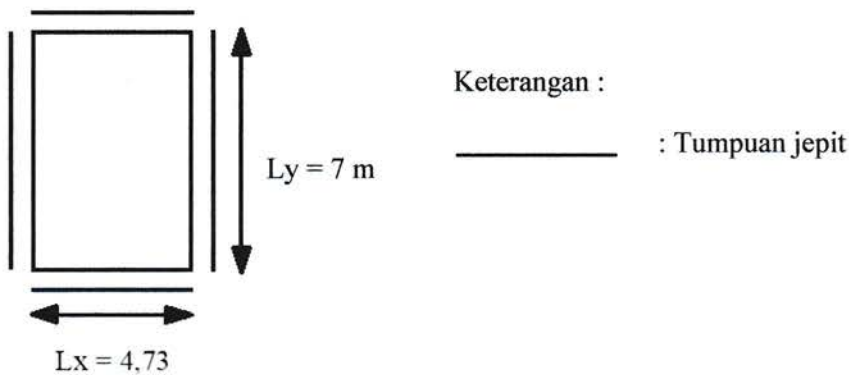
Bagian Plat Lantai yang di tinjau
